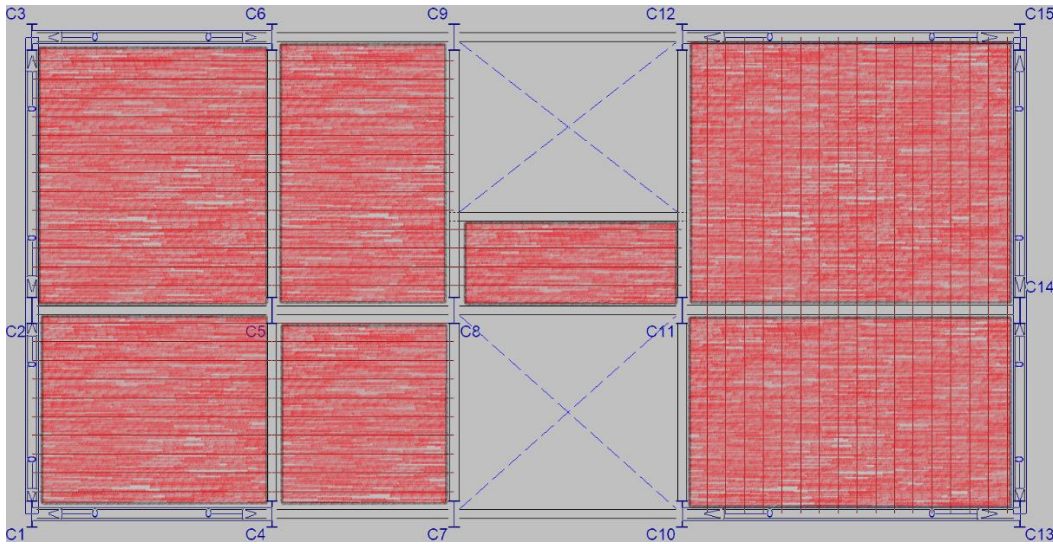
Losa aligerada con viguetas metálicas nivel 1
